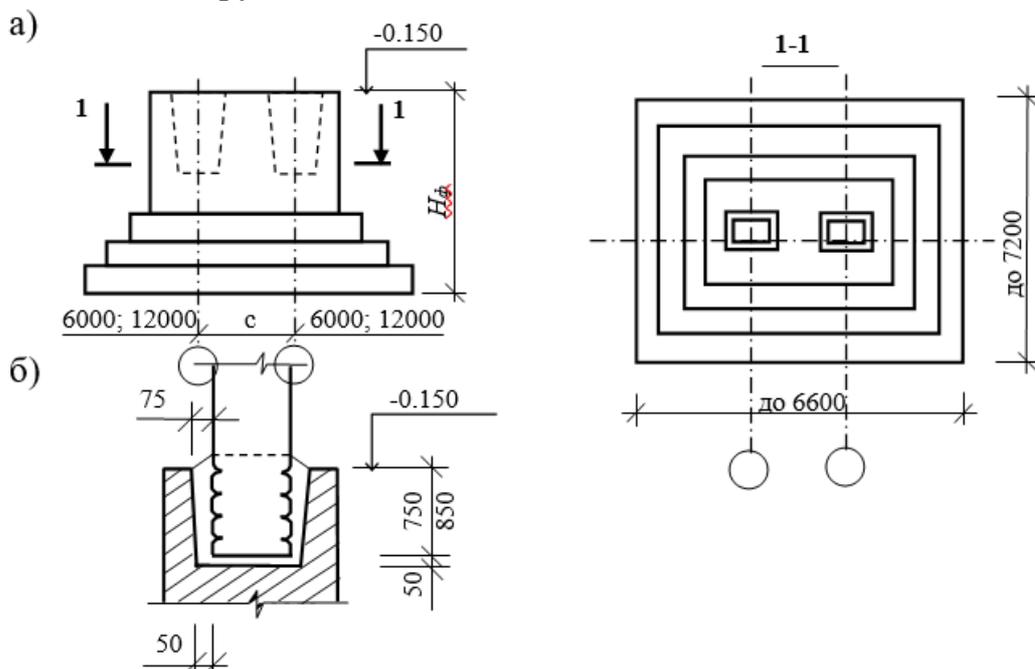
Сборный фундамент под железобетонные колонны
